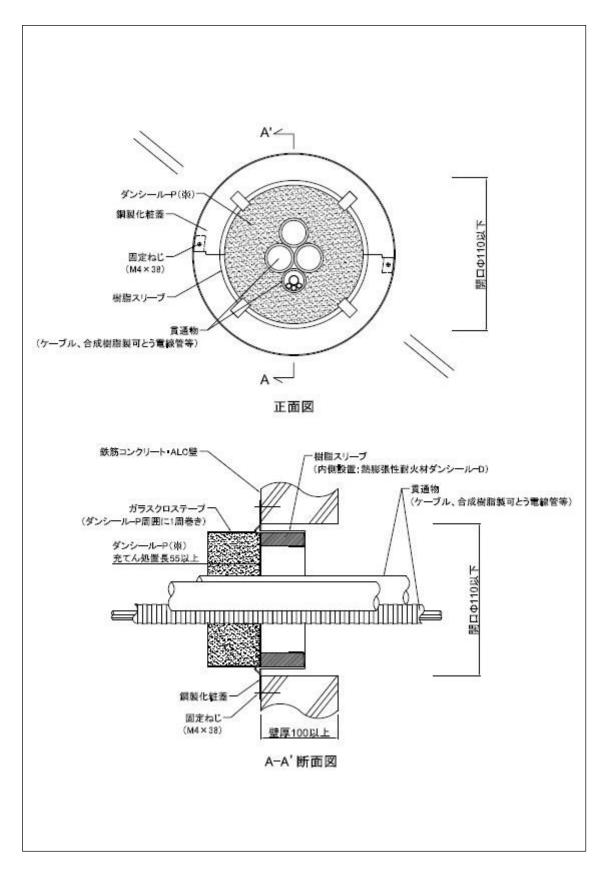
プチロクワイド消防キット 標準施工図(鉄筋コンクリート・ALC 壁)
